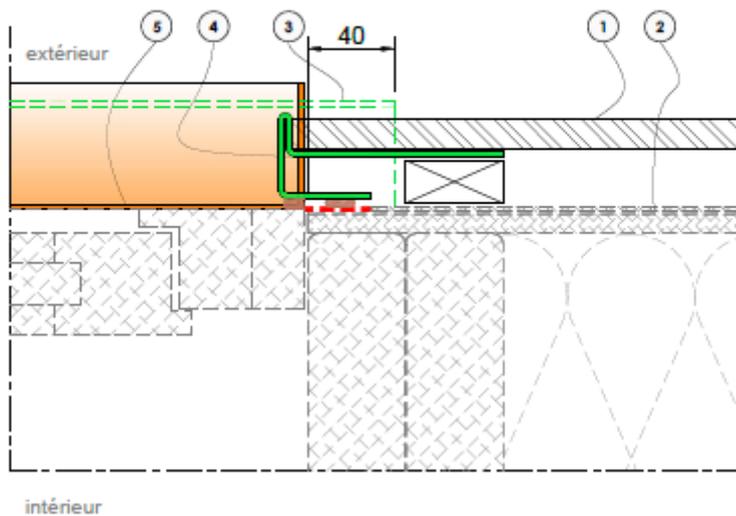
Menuiserie en tunnel au nu extérieur – Coupe sur appui de baie
